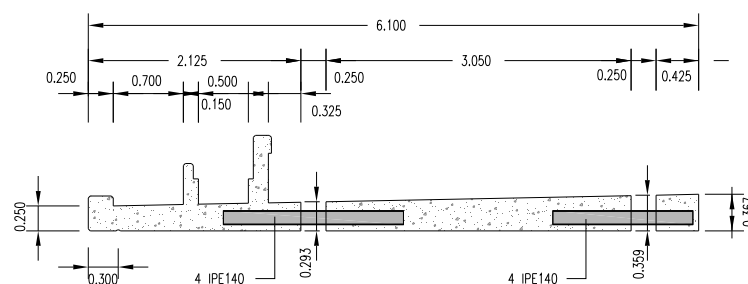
Ligação entre painéis pré-fabricados da laje do tabuleiro da ponte de Antuã.
